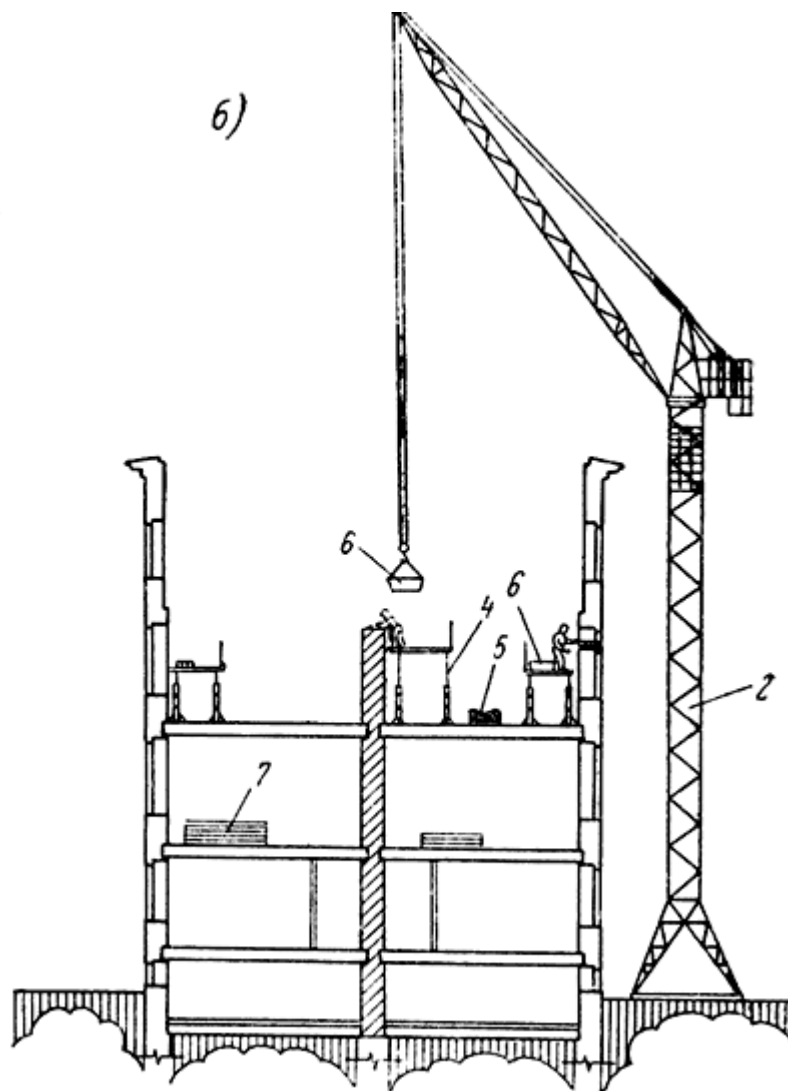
Общая схема организации работ по перекладке участка стены при комплексном капитальном ремонте жилого дома
